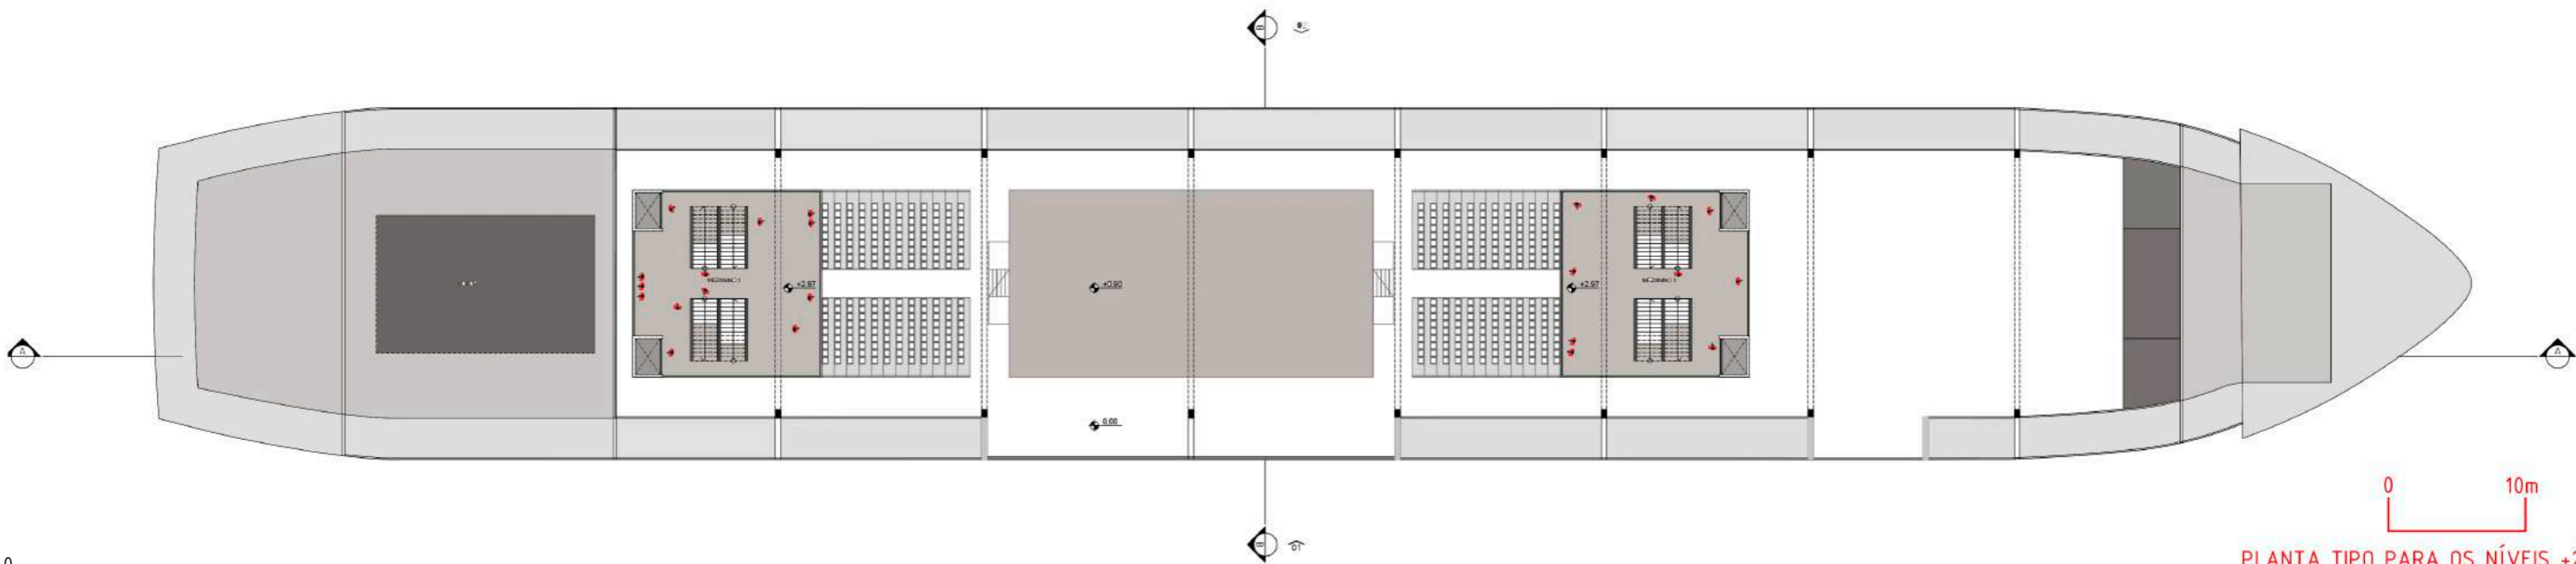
Planta tipo para níveis +2,97 e +5,70. Fonte: Autora.
